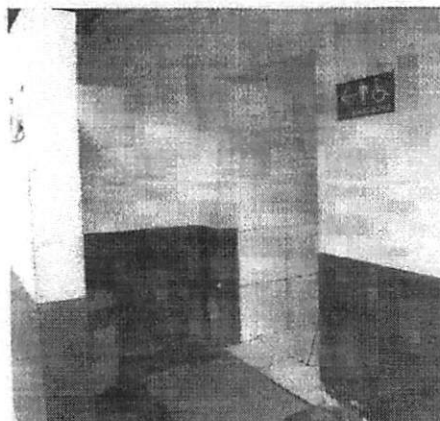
Terminal Tatico – Vista de acesso ao banheiro.
